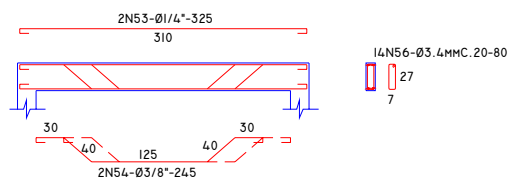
Planta de armação das vigas à nível de teto da edificação residencial.
